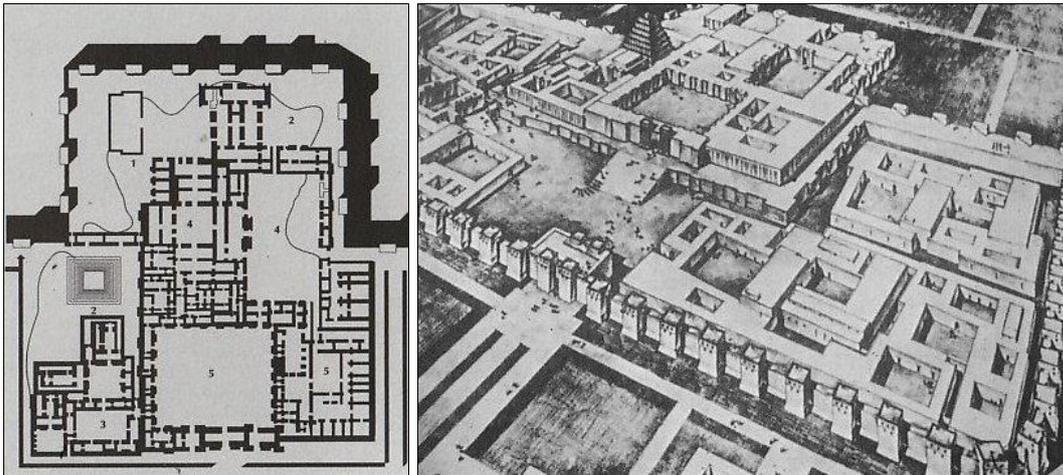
Planta e vista aérea (reconstituição) do palácio e da cidadela de Corsabade, Assíria
